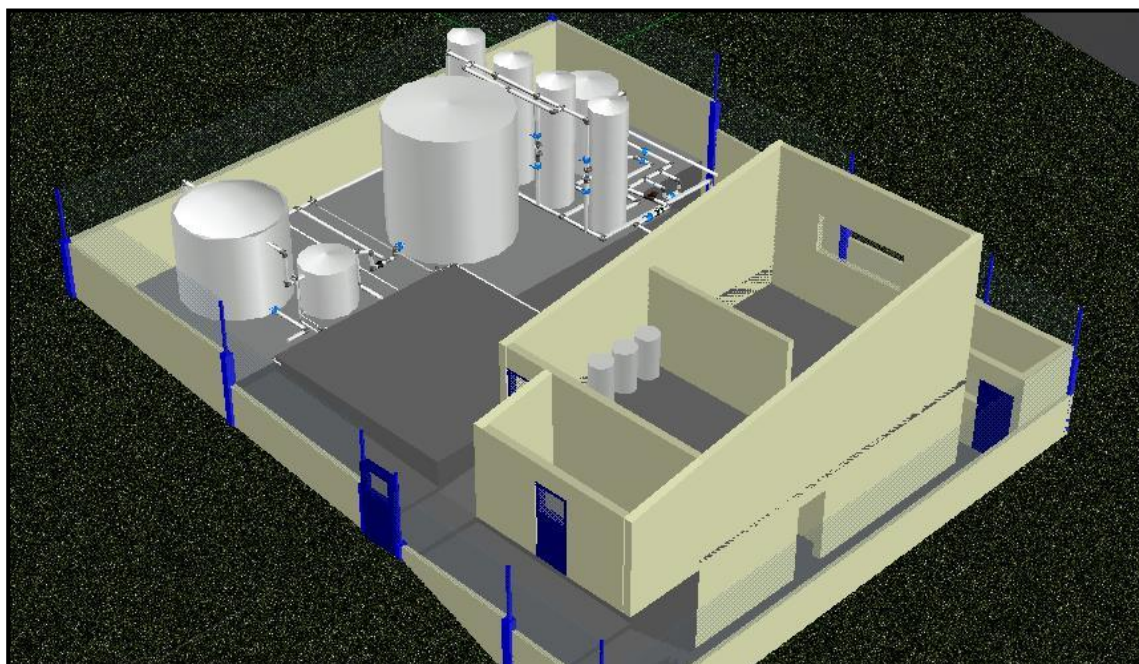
Planta de tratamiento vista superior o plano planta*Figura 57*Planta de tratamiento vista esquina o perfil esquinero
